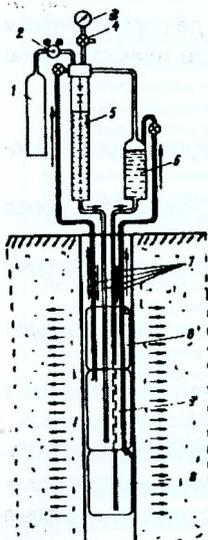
Прессиометр: 1 - газовый баллон; 2 - редуктор; 3 - манометр; 4 - кран-тройник; 5 - измерительный цилиндр; 6 - бачок; 7 - планки; 8 - вспомогательные камеры; 9 - рабочая камера.
